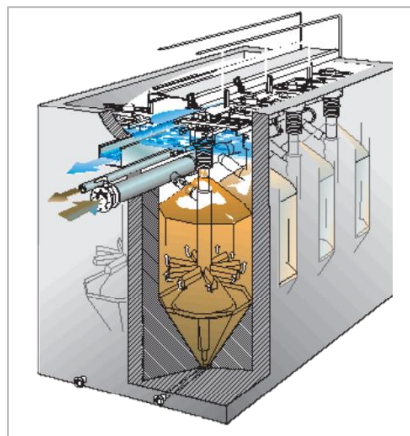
Betonbauweise eines kontinuierlich gespülten Sandfilters (Nordic Water Products AB., n.d.)
